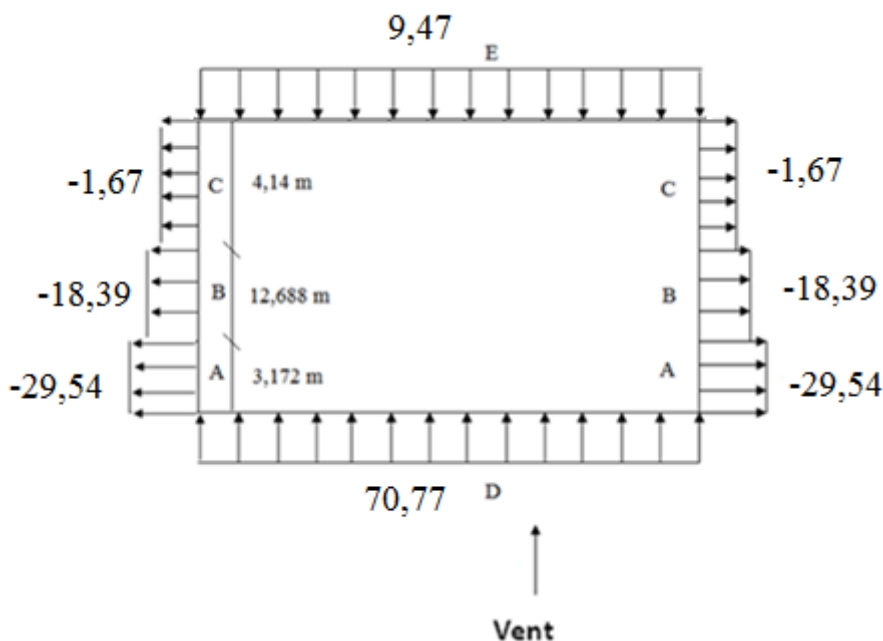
Pression statique du vent q_j sur les parois verticale (vent sur long pan2)
